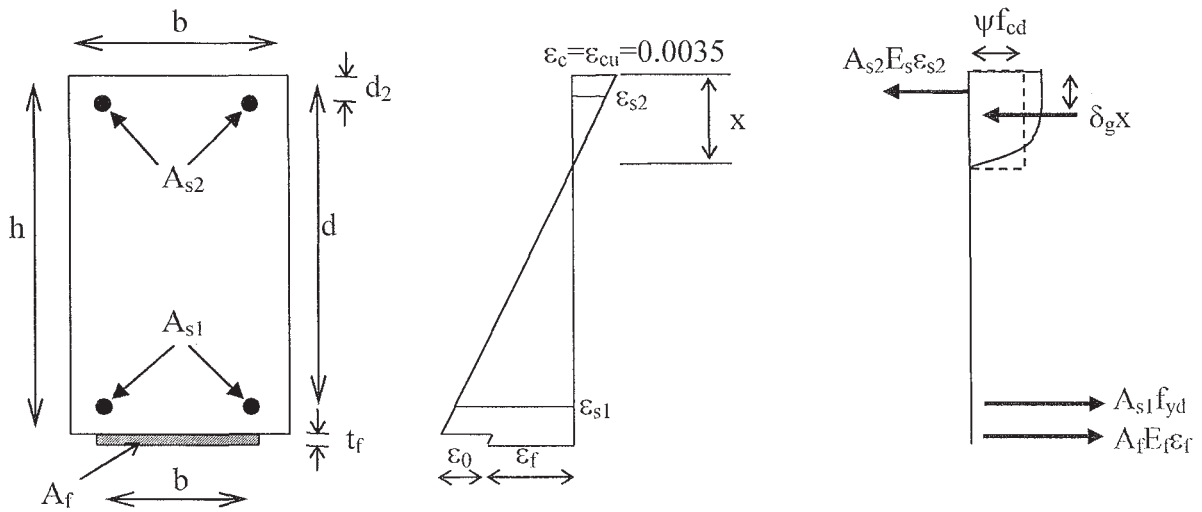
Calculul secțiunii dreptunghiulare la SLU
